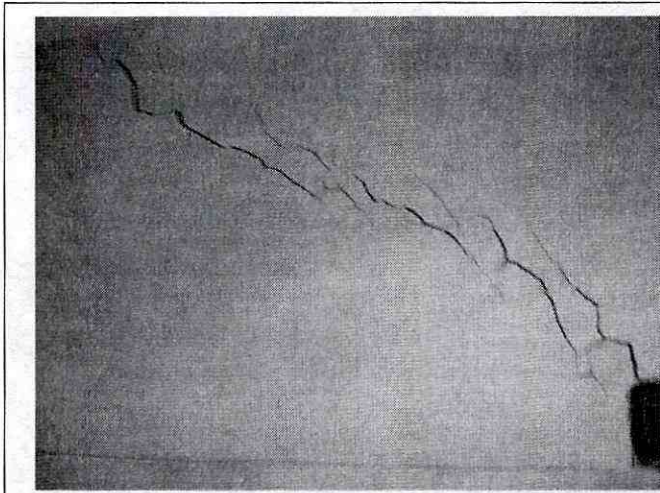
Se Observan las grietas de tendencia diagonal, en el muro del baño del cuarto principal de la parroquia.
